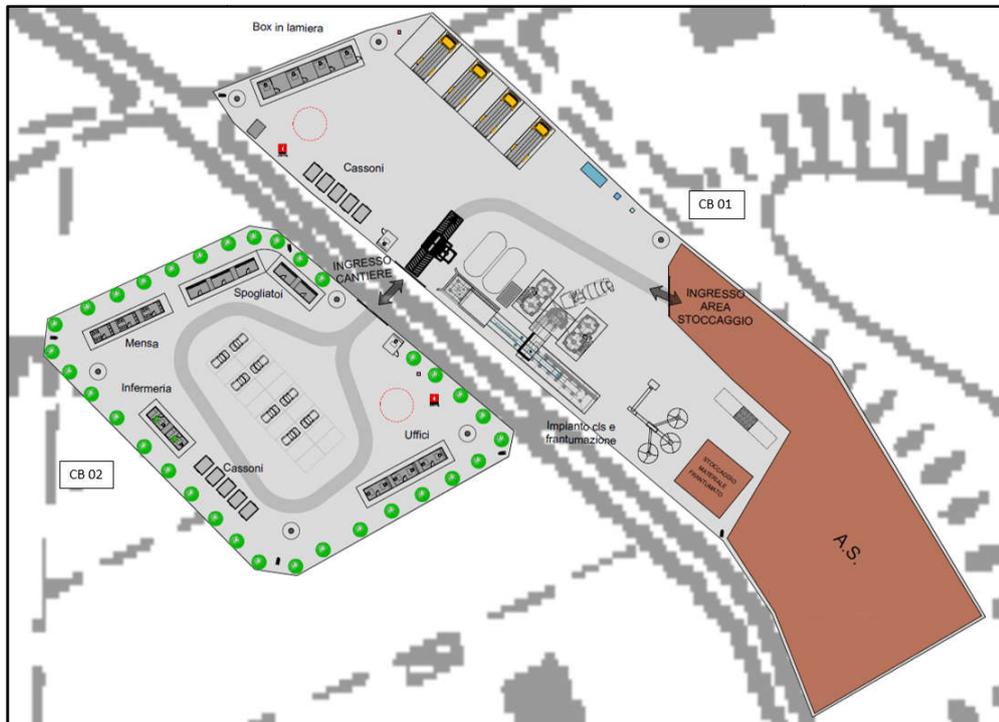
Layout cantieri base CB 01 e CB 02
